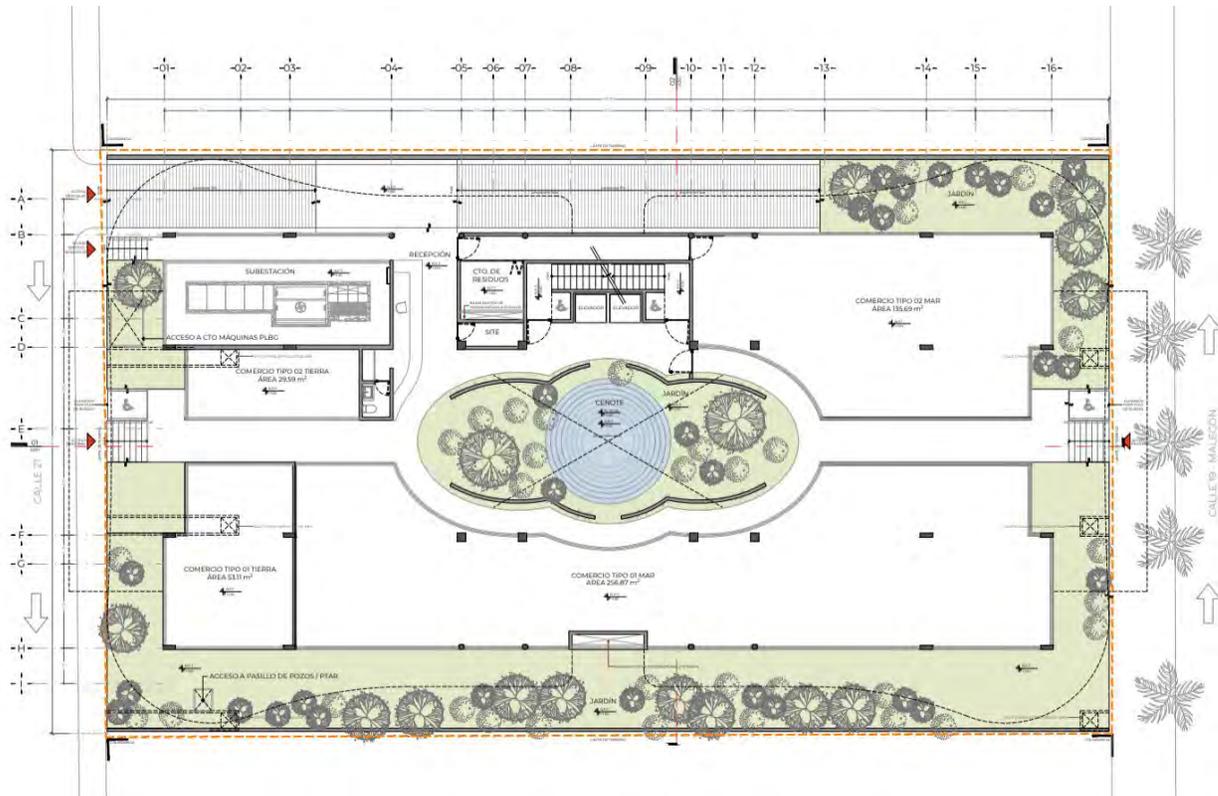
Plano de la superficie para el desplante de la Planta baja (Se anexan planos a detalle).
